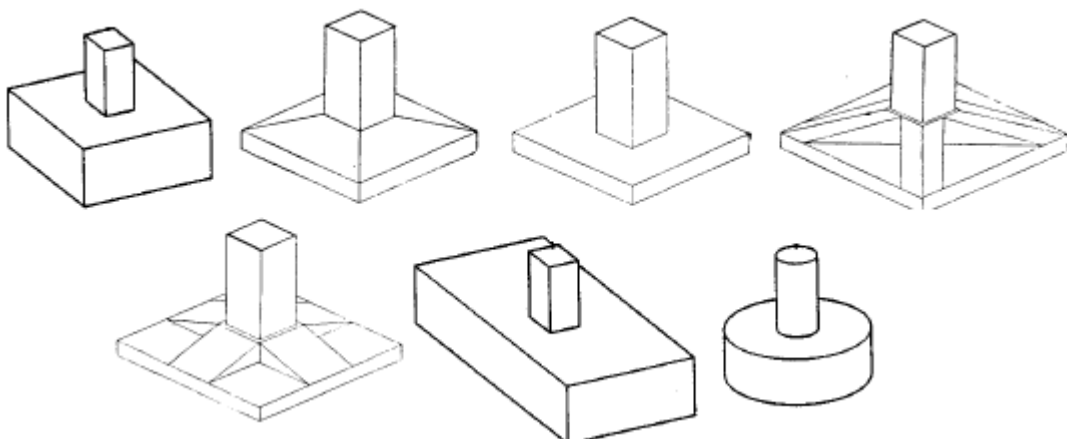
Esquemas de diversas geometrias possíveis para sapatas isoladas [21]
